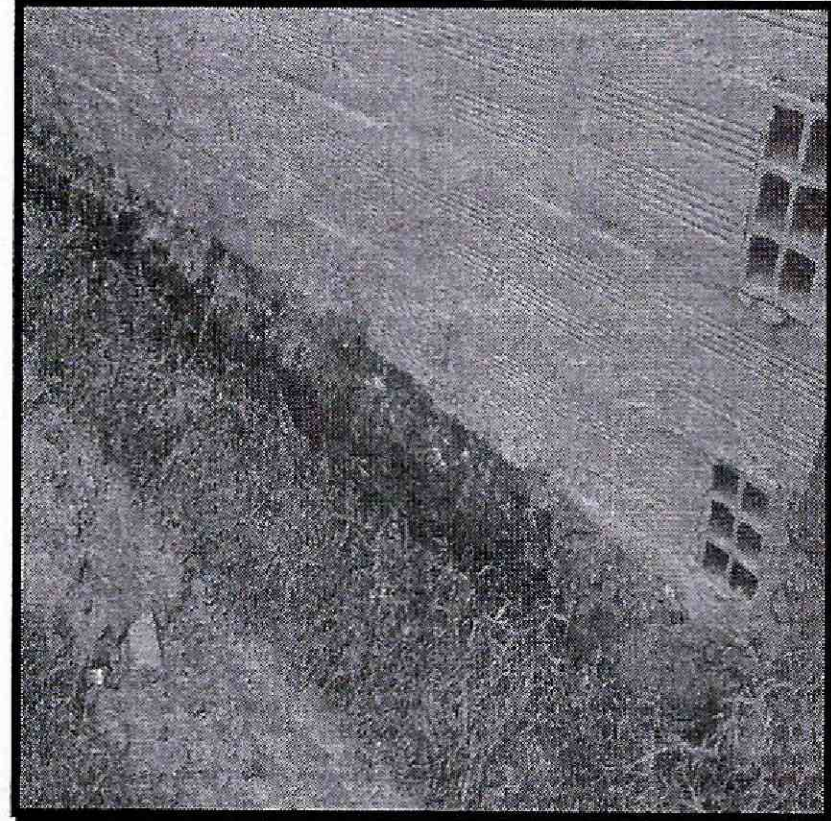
Cinco viviendas emplazadas en la parte baja de la Ladera.
